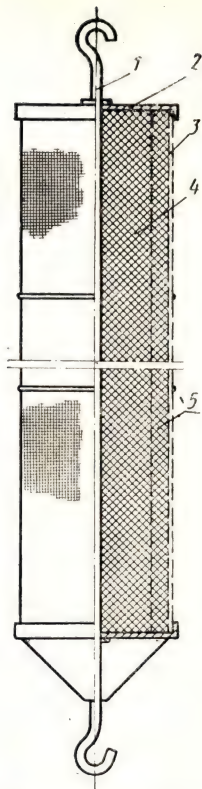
Схема звукопоглотителя для вертикального глушителя:
